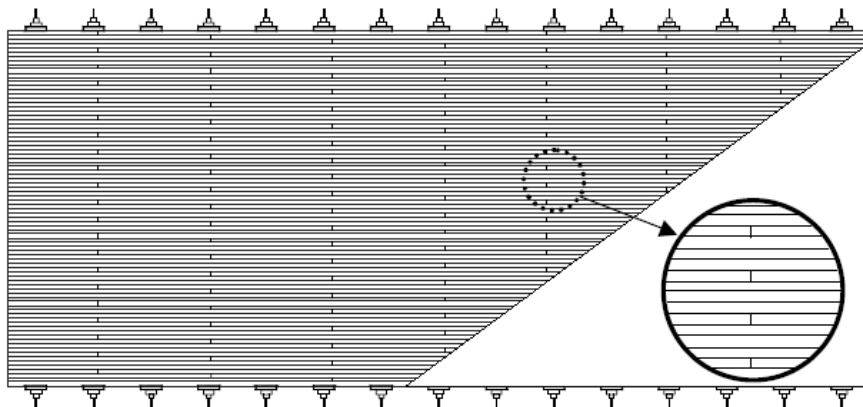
Detalhe de seção de ponte utilizando madeira laminada protendida
